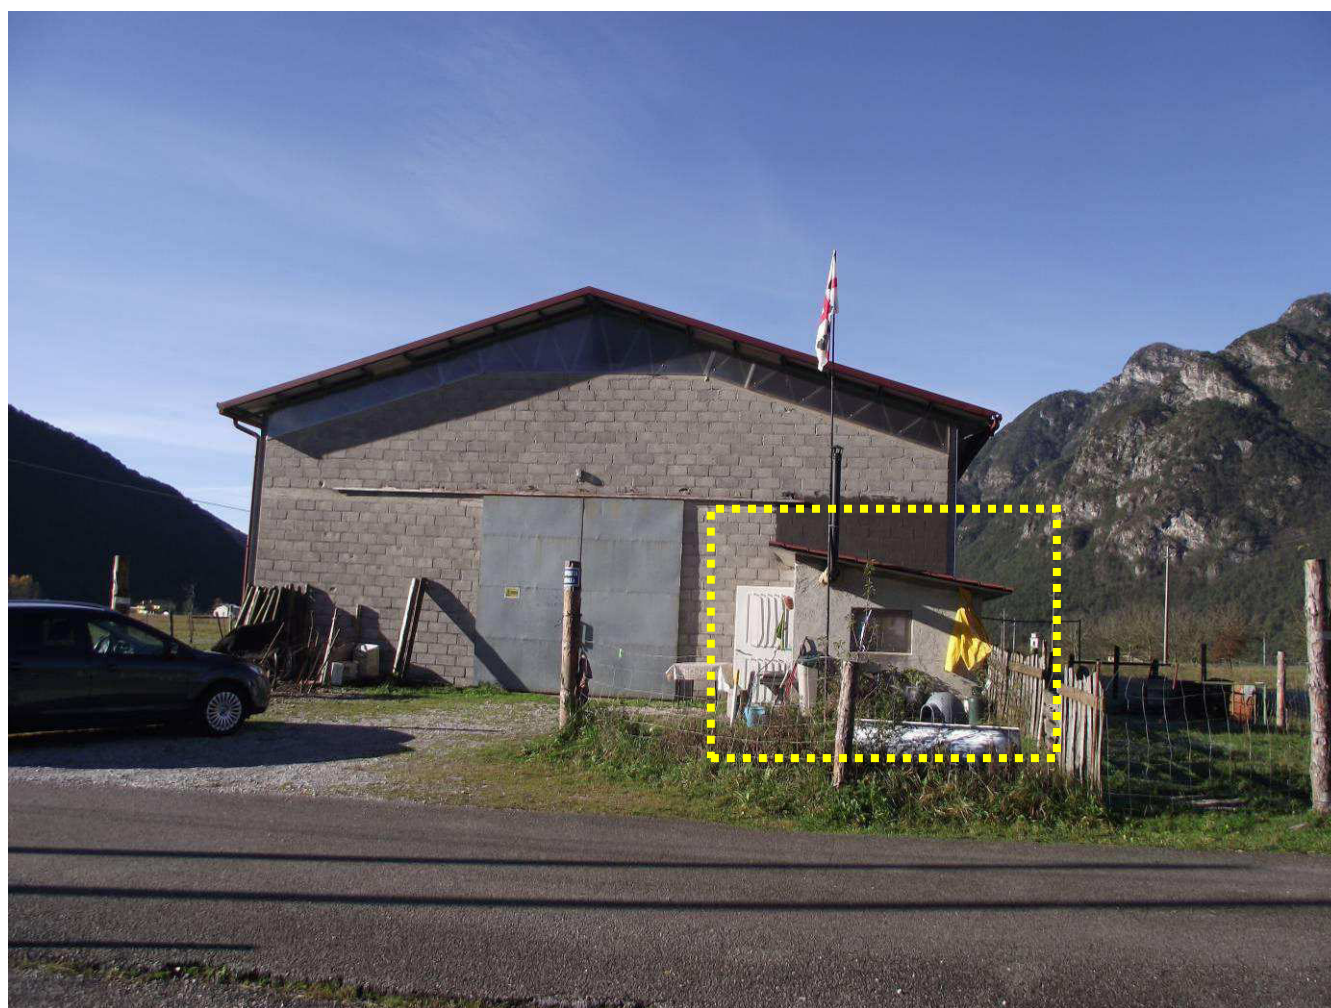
prospetto principale (evidenziala la parte abusiva)
